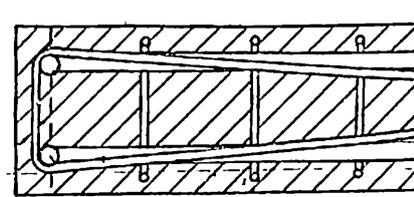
6. На коротких опорах крюки на стержнях крупного диаметра нельзя допускать без установки дополнительных шпилек
